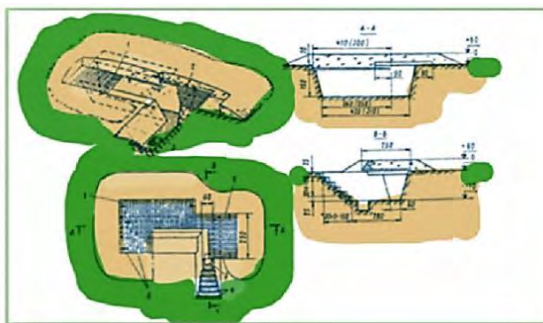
а. – Перекрита щілина на відділення (екіпаж, обслугову): 1– перекриття; 2 – перекрита ділянка входу; 3 – водозбірний колодезь; 4 – жердини; 5 – скрутки з 3-4 мм дроту в 4 нитки
